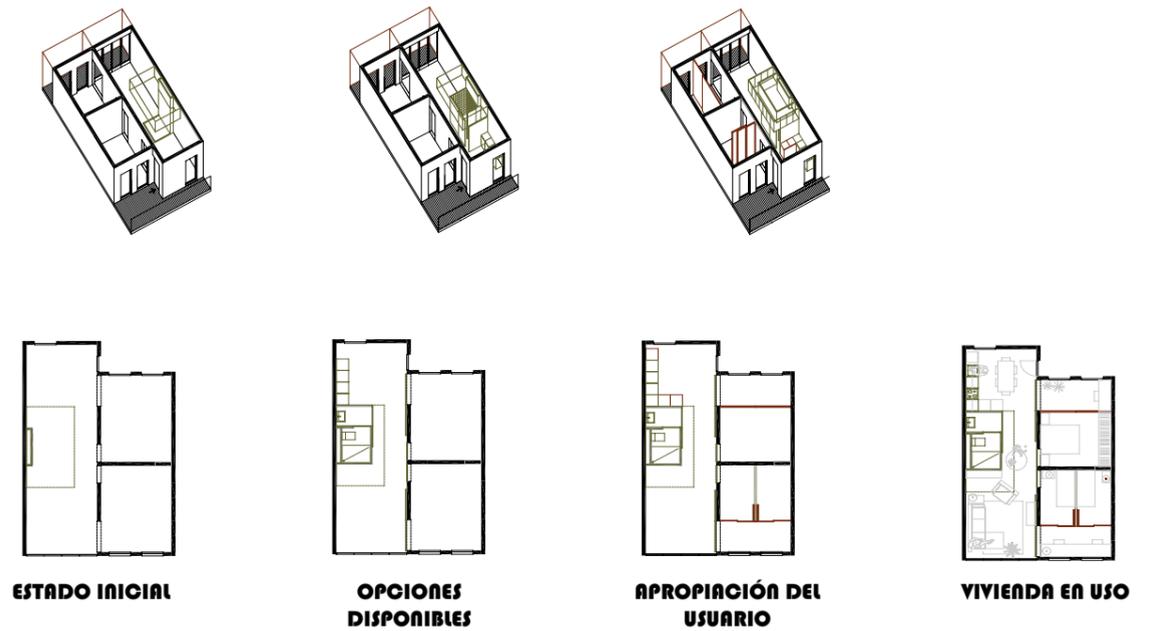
Flexibilidad y adaptabilidad en planta de vivienda para el edificio.
